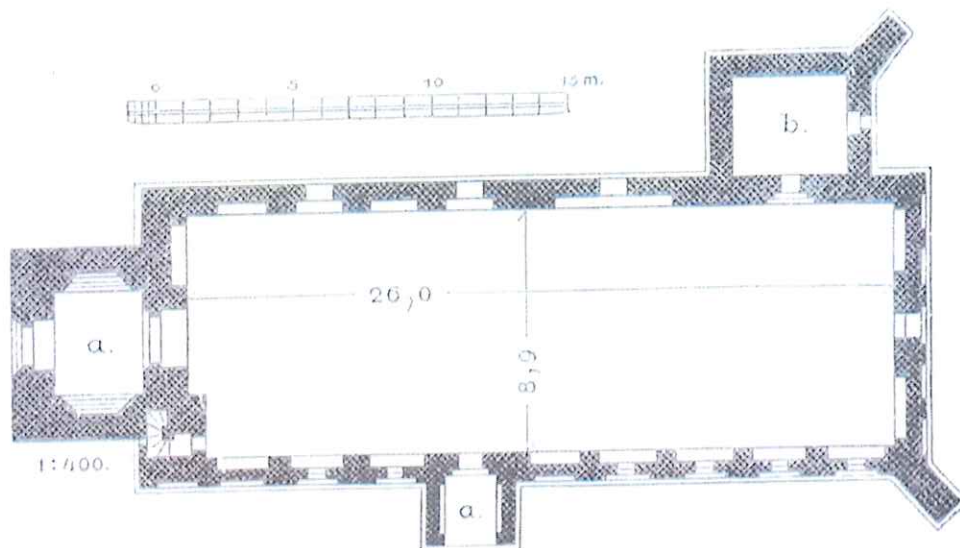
Żmiewo. Grundriss der Kirche.
